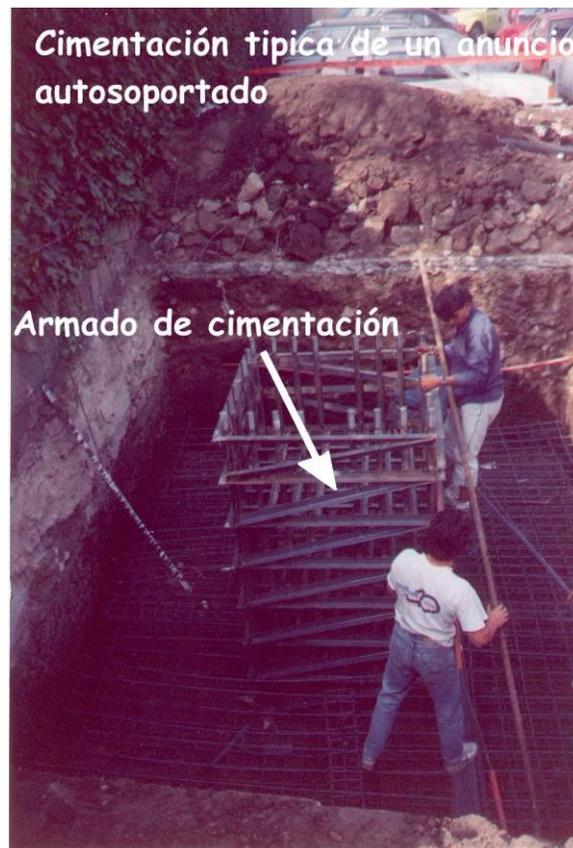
Armado de la zapata y dado para la cimentación de anuncio autosoportado
